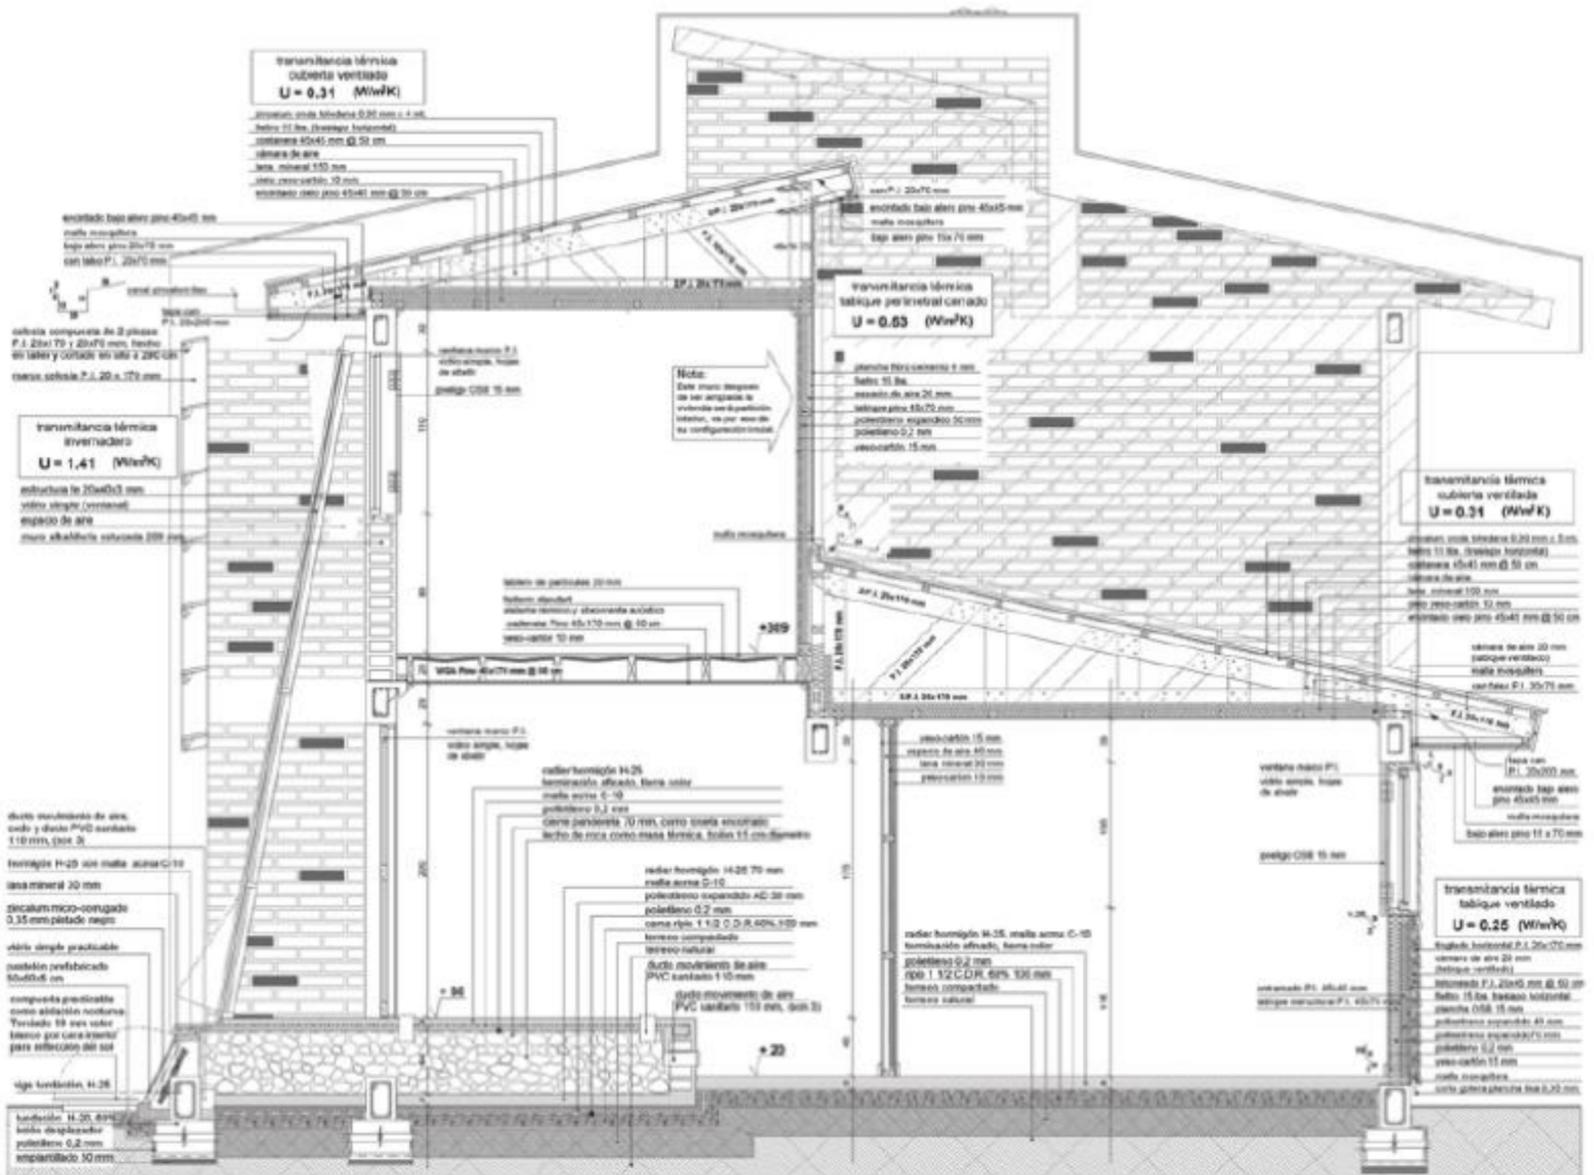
Sección corte constructivo vivienda inicial 49 m2
